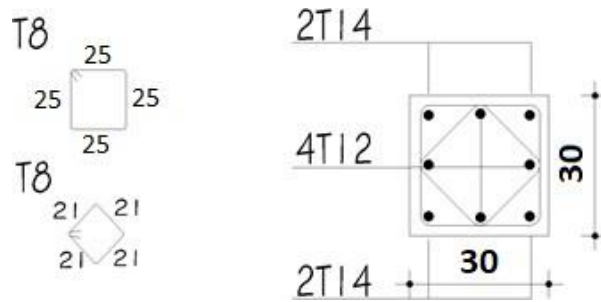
Dessin de ferrailage de poteau (30x30).
